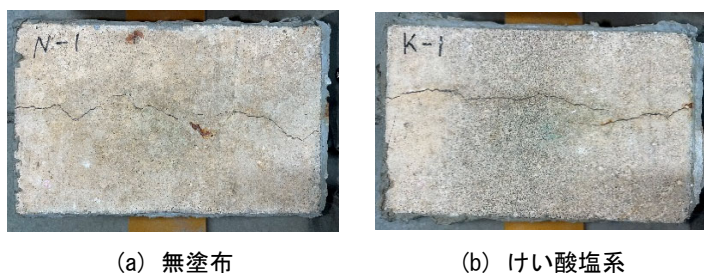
無塗布とけい酸塩系のひび割れの様子
